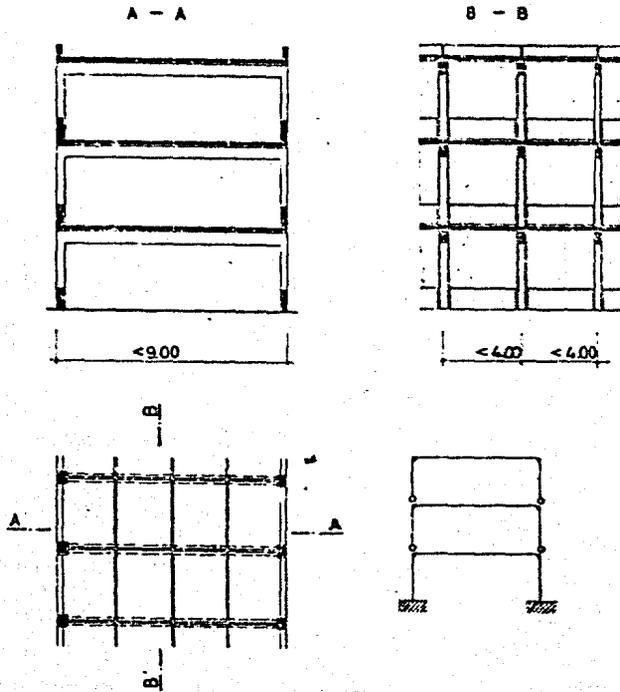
Estructura de pórticos biarticulados superpuestos. Con pequeñas distancias entre cruces, los forjados pueden ser simples placas masizas de hormigón armado.
